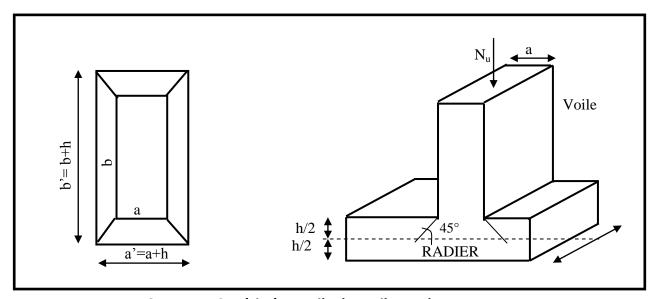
Périmètre utile des voiles et des poteaux
